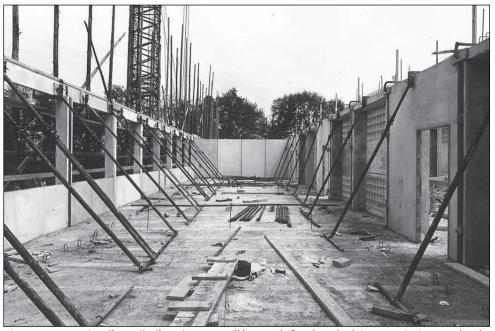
Construction d'une aile d'enseignement : éléments de façade et de cloison provisoirement étayés.
